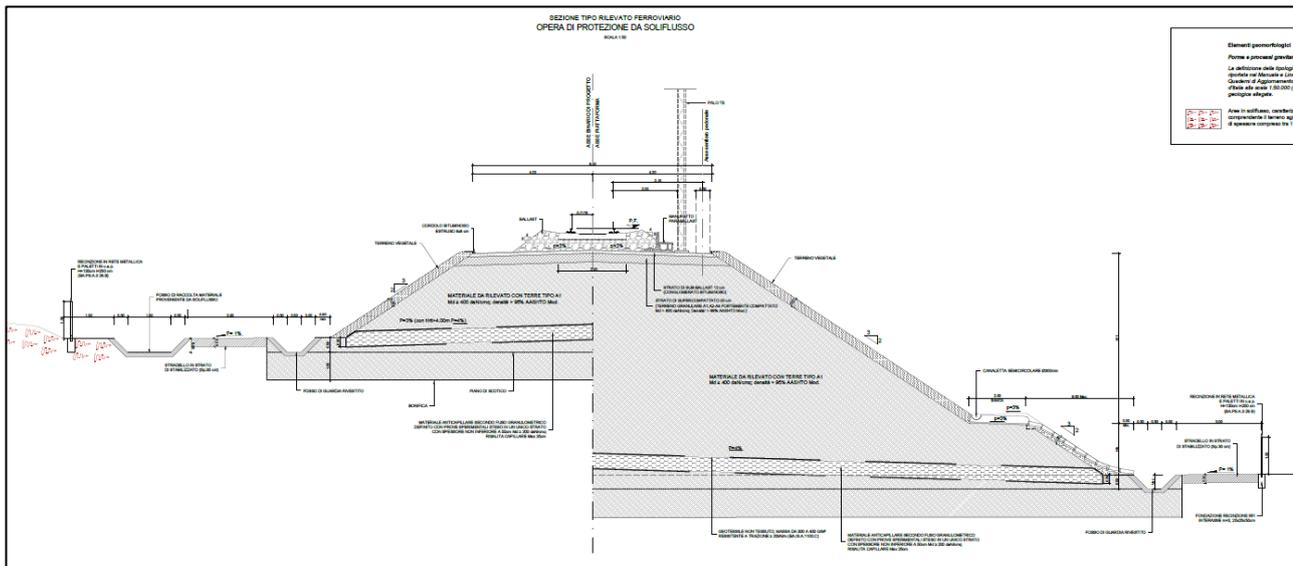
Sezione tipo rilevato ferroviario – opera di protezione da soliflusso
